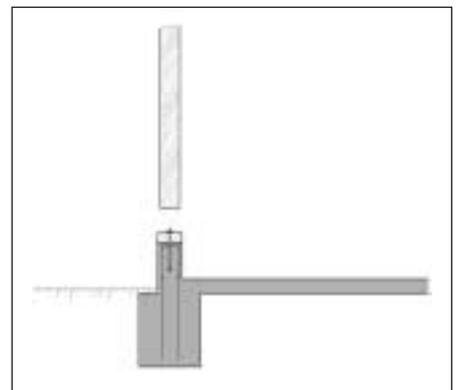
Streifenfundament mit Sockelwand. Auf der betonierten Sockelwand wird ein waagrechtter Balken befestigt. Die Verankerungsschrauben werden in den frischen Beton gestossen.
